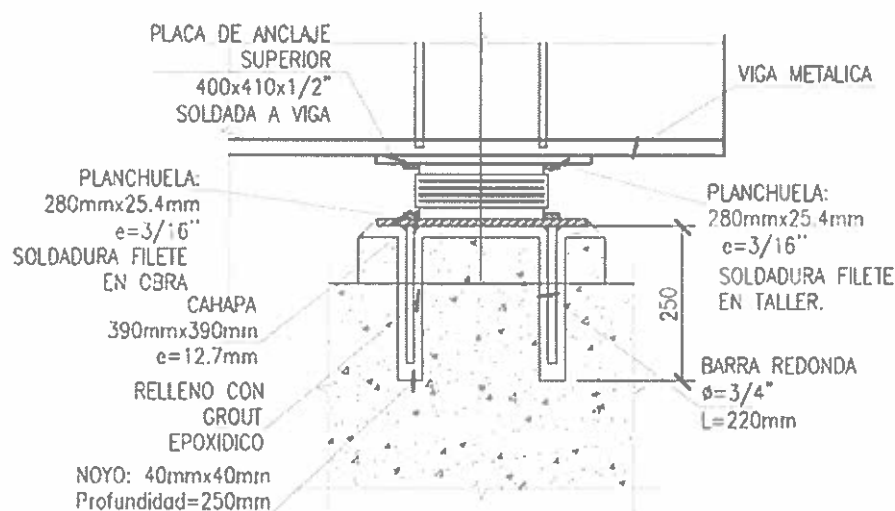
Detalle apoyo armado de neopreno en tableros metálicos.
